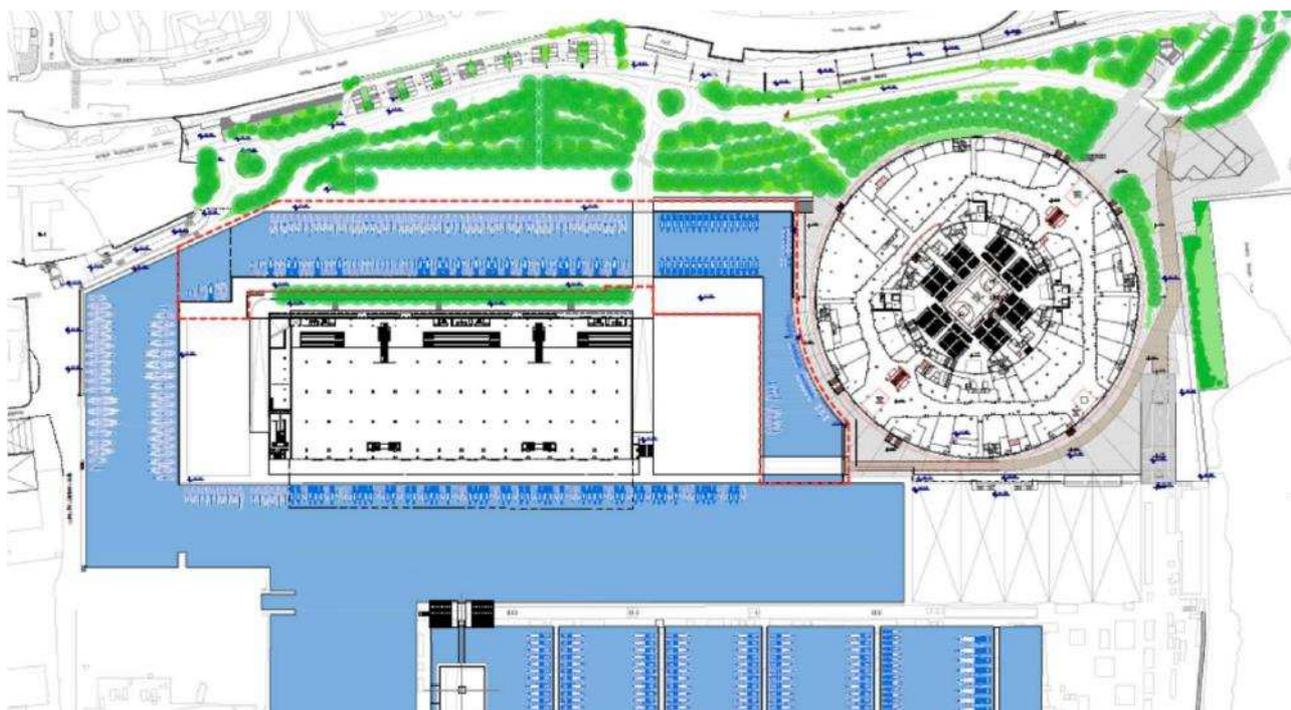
Planimetria generale di progetto a quota +5,50 – Stralcio elaborato SIA.T02.
